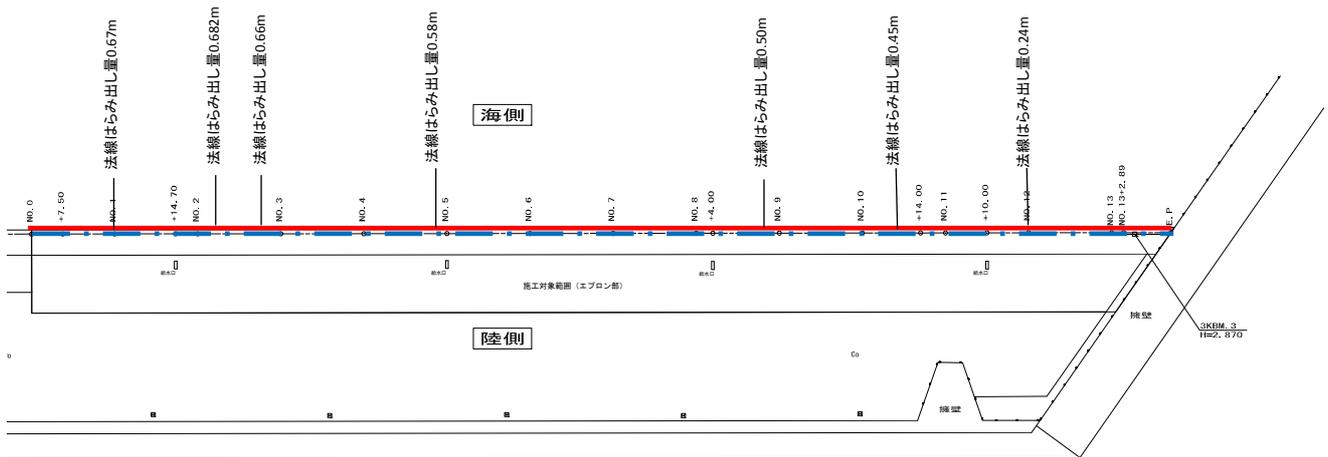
No.23 常陸那珂港区_南ふ頭地区 C岸壁 (-7.5m) の平面図 (被災後)
